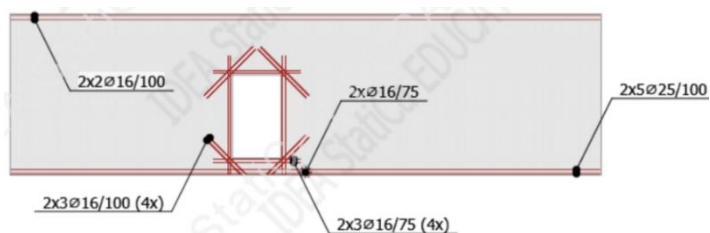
Armaduras atribuídas para a viga-parede simples baseada na análise anterior.
